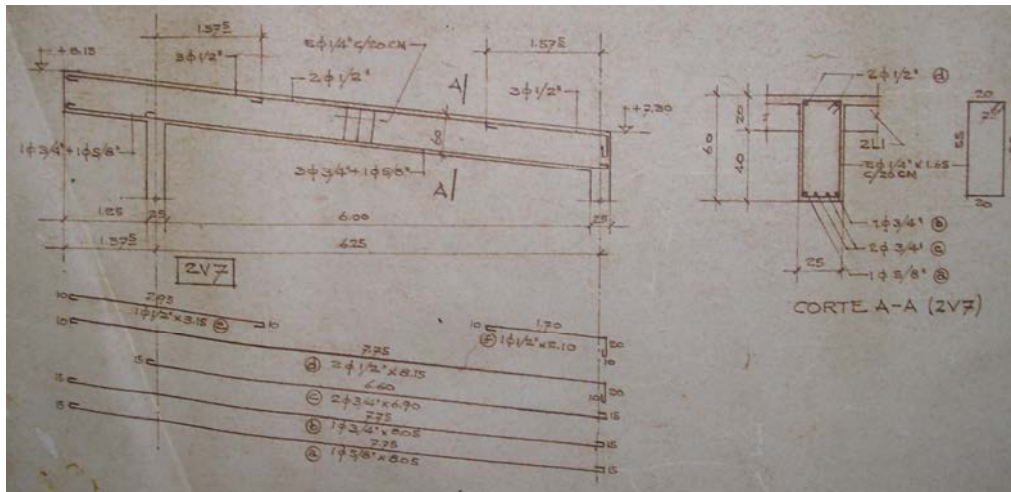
Corte y sección transversal del Techo. Tipo Antigo II
